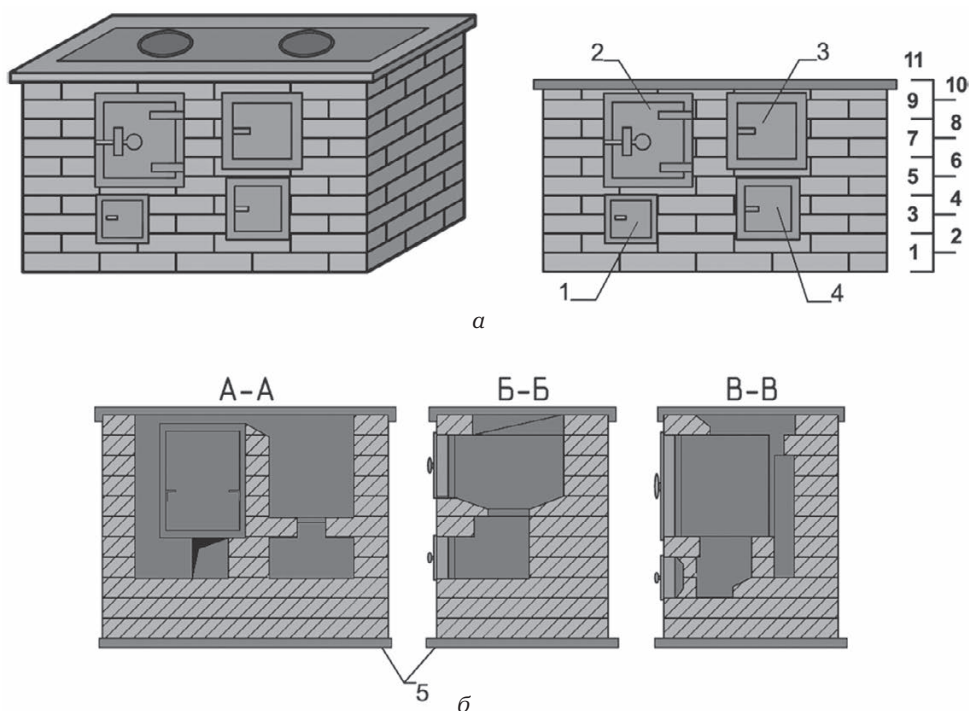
Кухонная плита с духовкой: а — общий вид; б — вертикальные разрезы; 1 — чистка; 2 — духовка; 3 — топливник; 4 — поддувало; 5 — войлок, покрытый кровельной сталью
